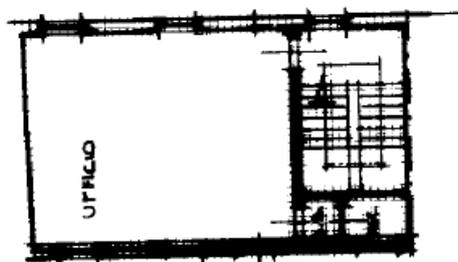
Estratto della planimetria catastale dell'ufficio posto al piano secondo
